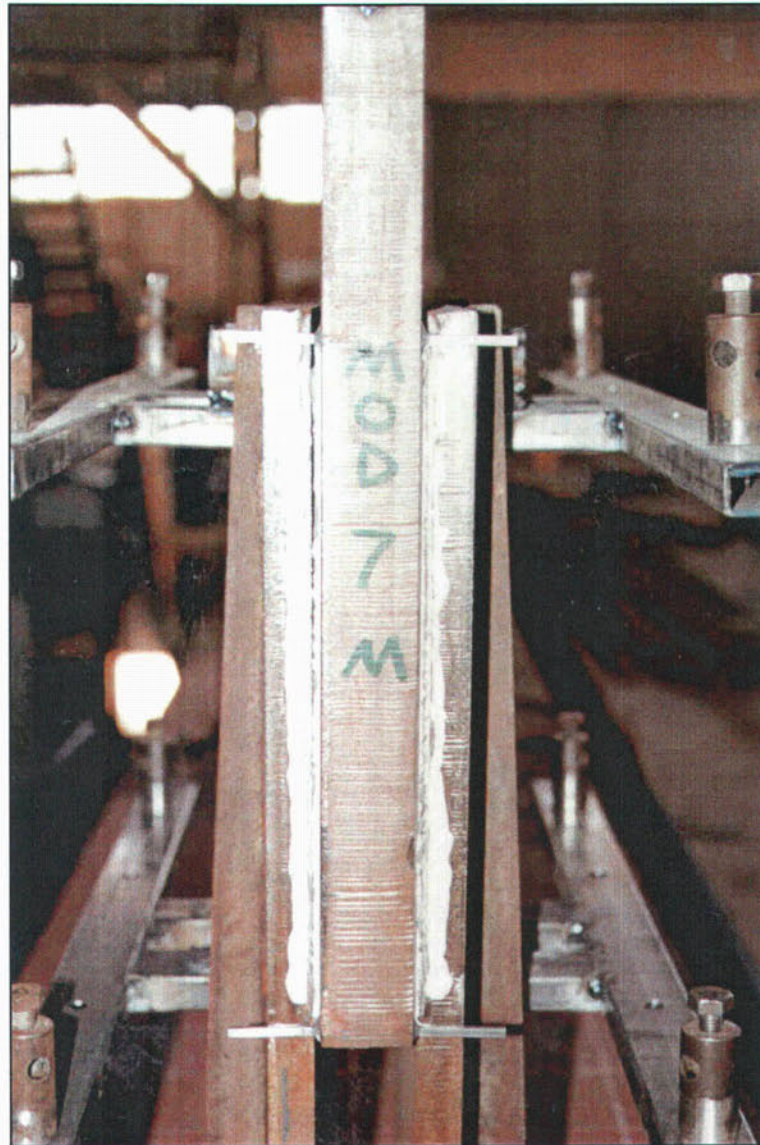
Detalle de la probeta 7M ya rota. Se observa en la fotografía la rotura de las soldaduras 1-3 y 2-4. La rotura nuevamente se produce por la sección de garganta de las soldaduras.
